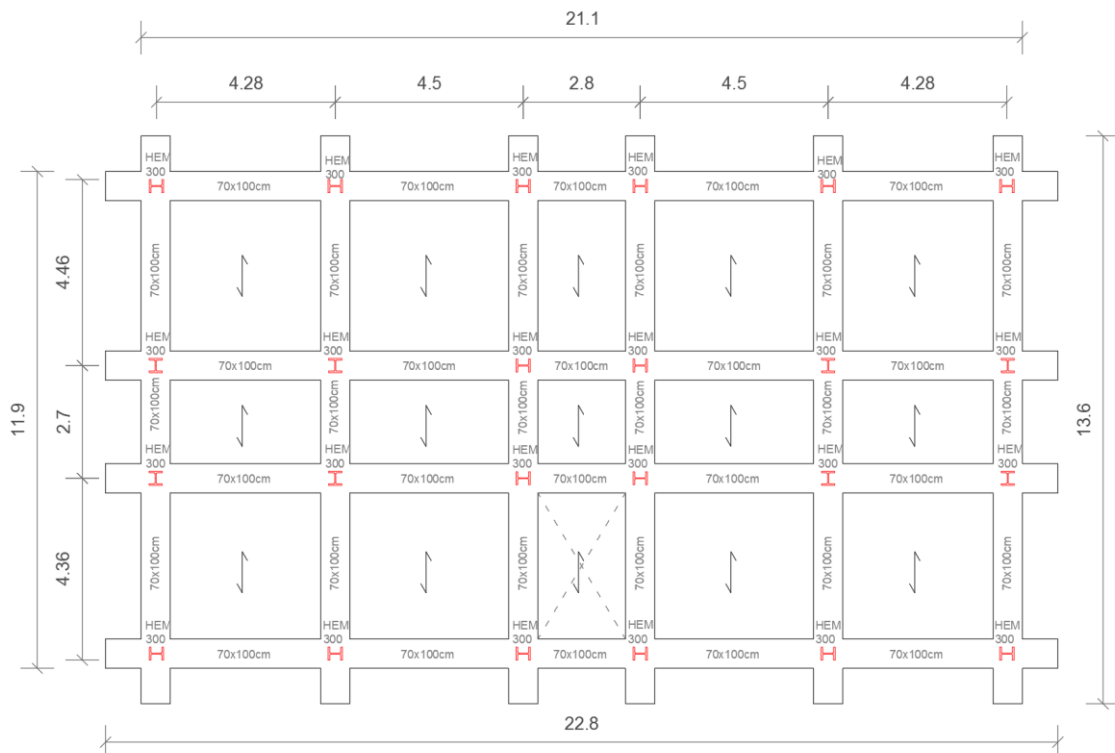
Carpenteria struttura in acciaio a tre piani con graticcio di travi rovesce.
